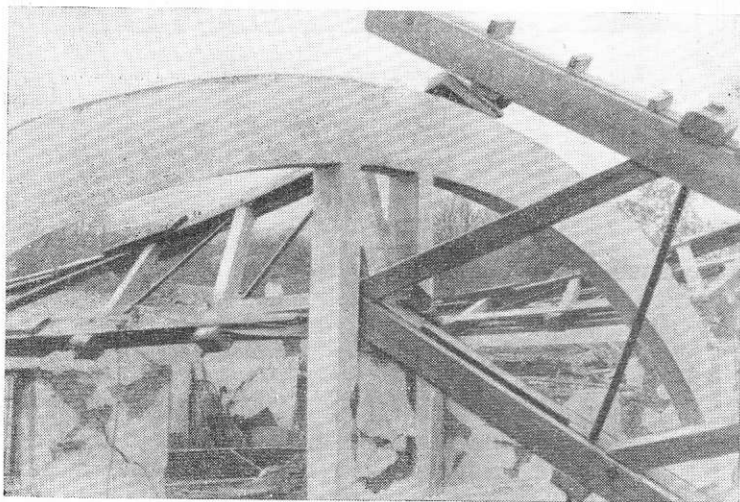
Обрушение деревянных ферм, опиравшихся на железобетонные арки
